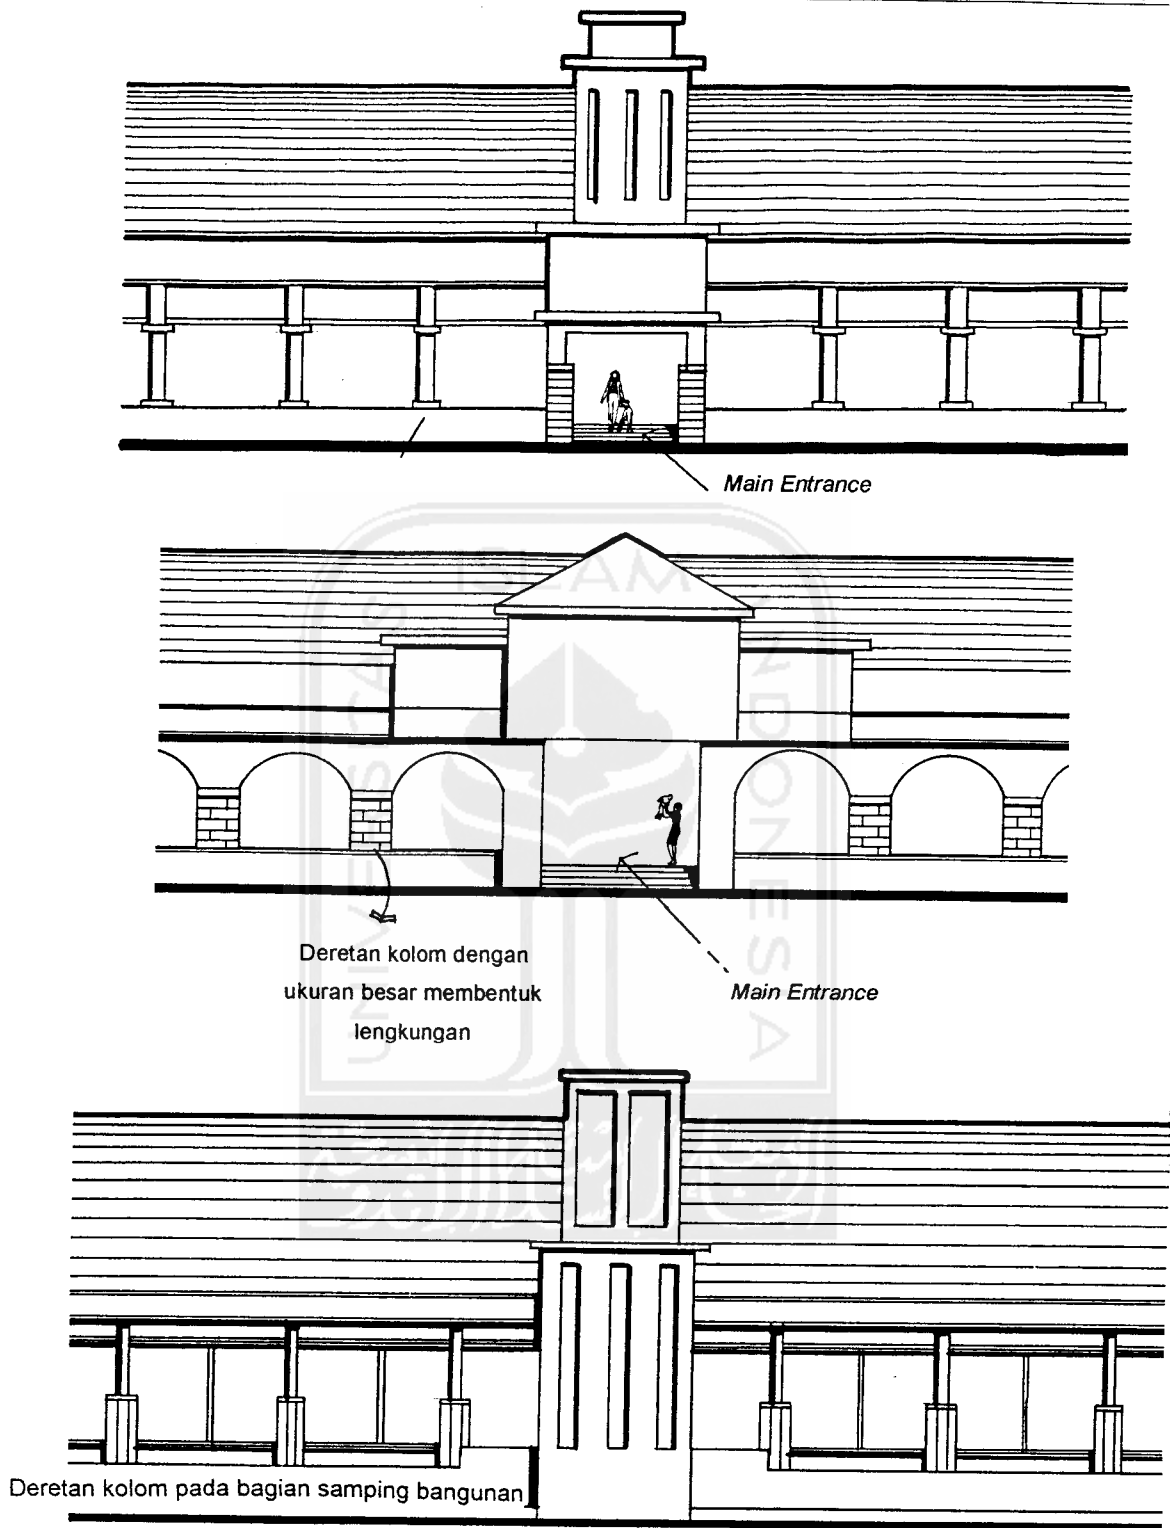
Detail Kolom Gedung HVA di Surabaya
